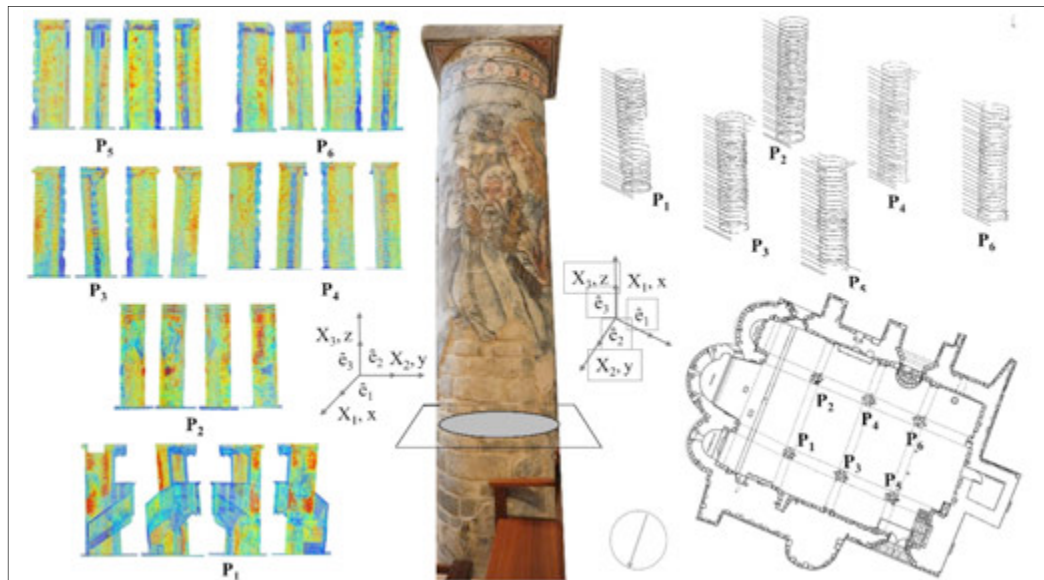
Caracterización de los desplazamientos pilares de Santa María d'Arties
